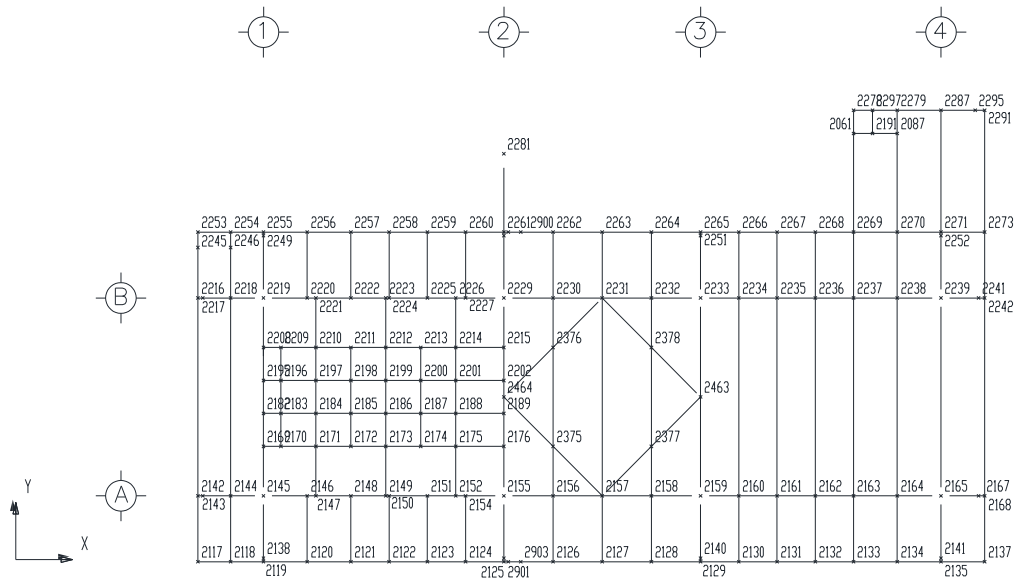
Nodos en Cubierta Superior Elev. (+) 27.145 m, superestructura
